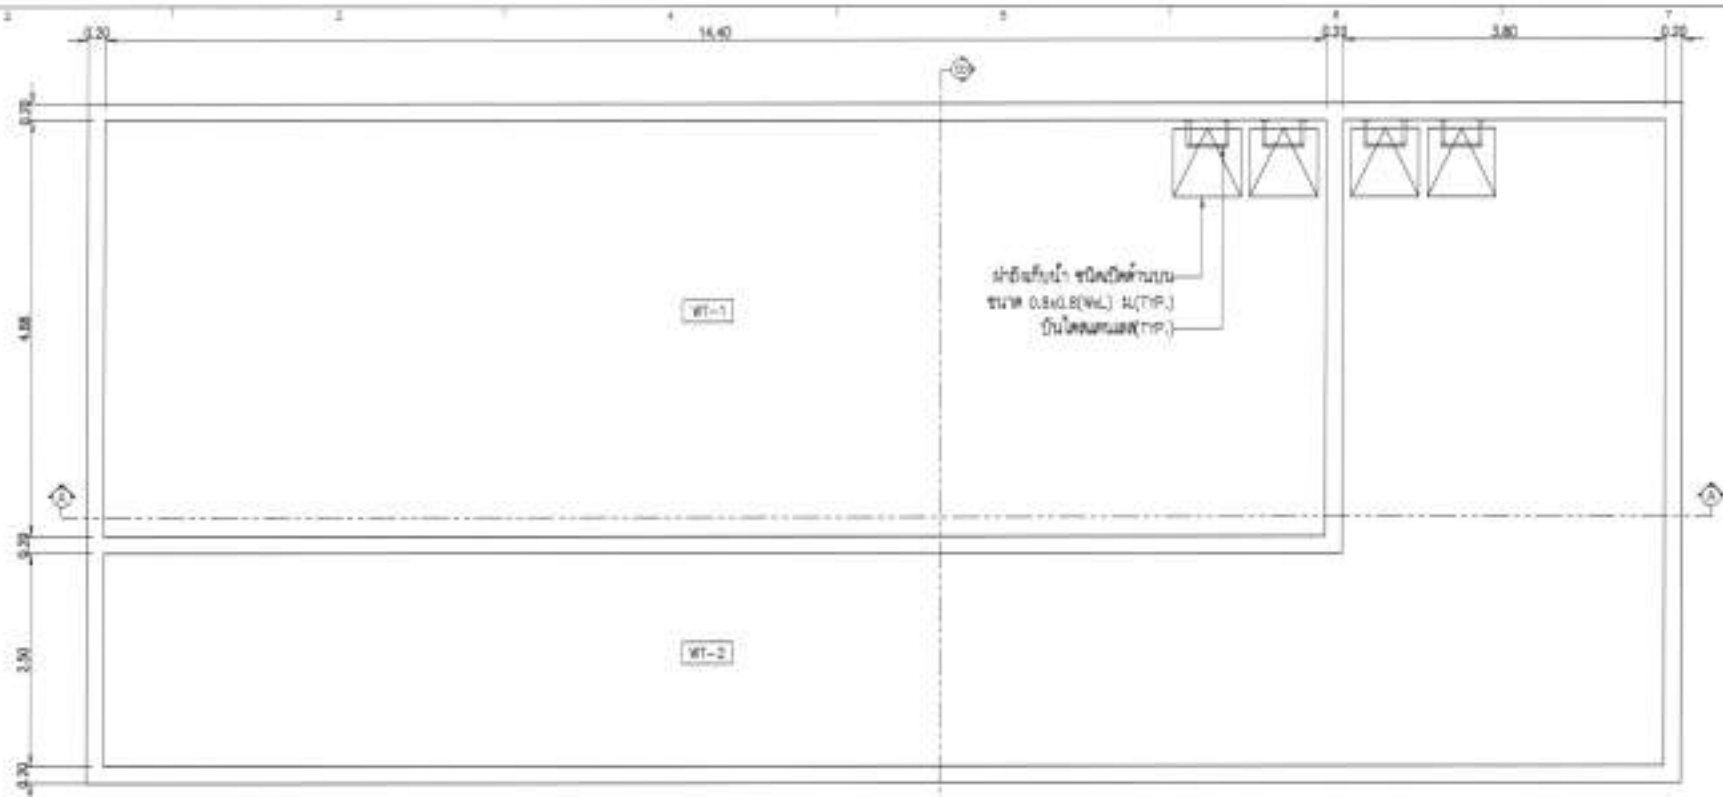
แผนผังตั้งระบบน้ำใช้ของโครงการ (ส่วนที่ 1)
